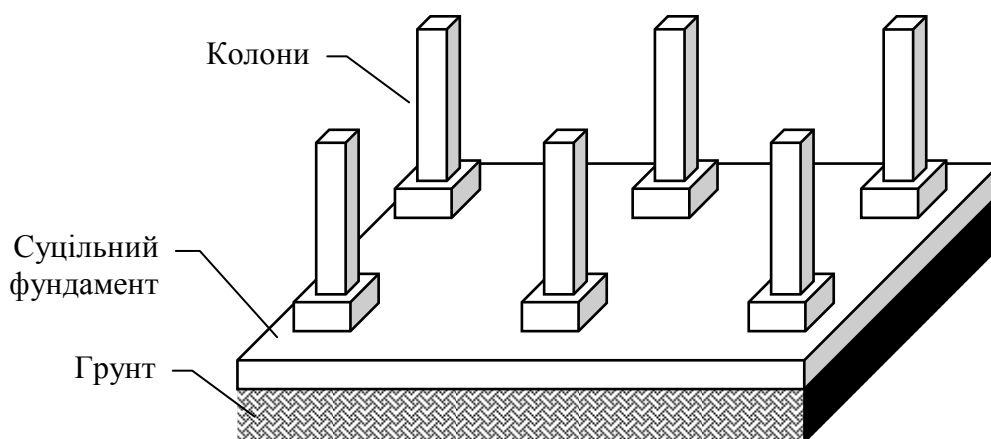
Приклад конструкції суцільного фундаменту
